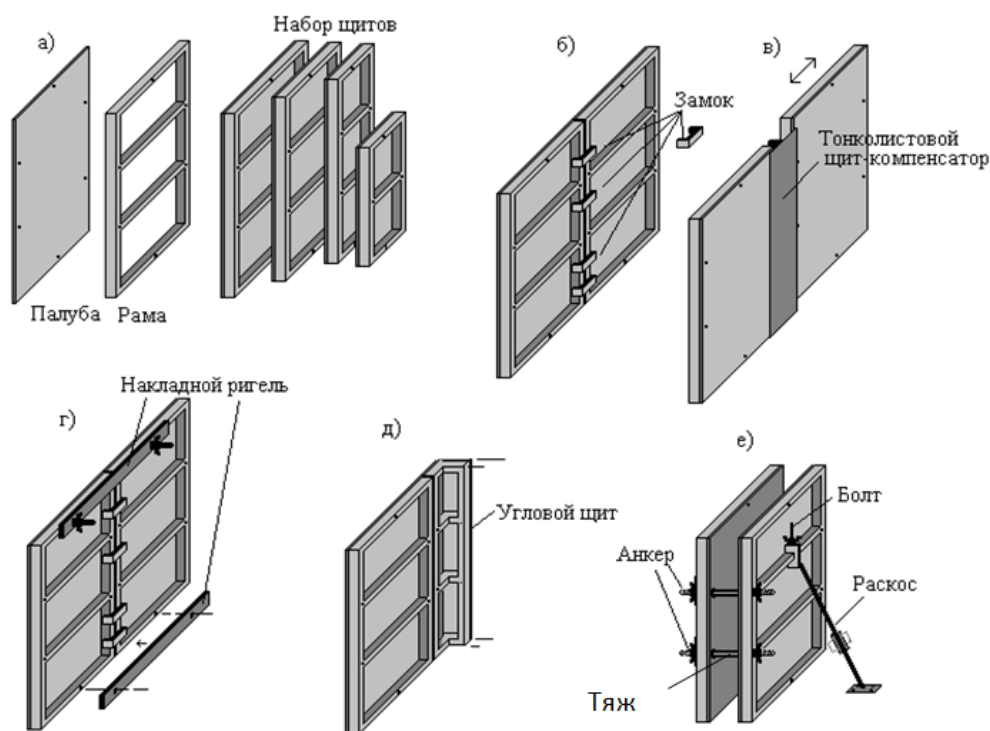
Конструкция вертикальной опалубки: *а* – щиты опалубки; *б* – замковое соединение щитов; *в* – использование щитов-компенсаторов; *г* – использование накладных ригелей; *д* – использование углового щита; *е* – использование дополнительных фиксирующих устройств
